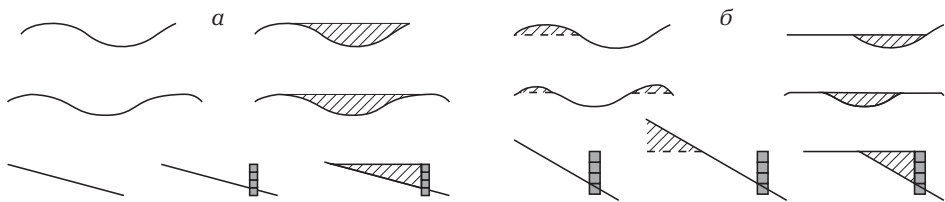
Выравнивание площади под теплицу: а — завозным грунтом, б — грунтом по месту
